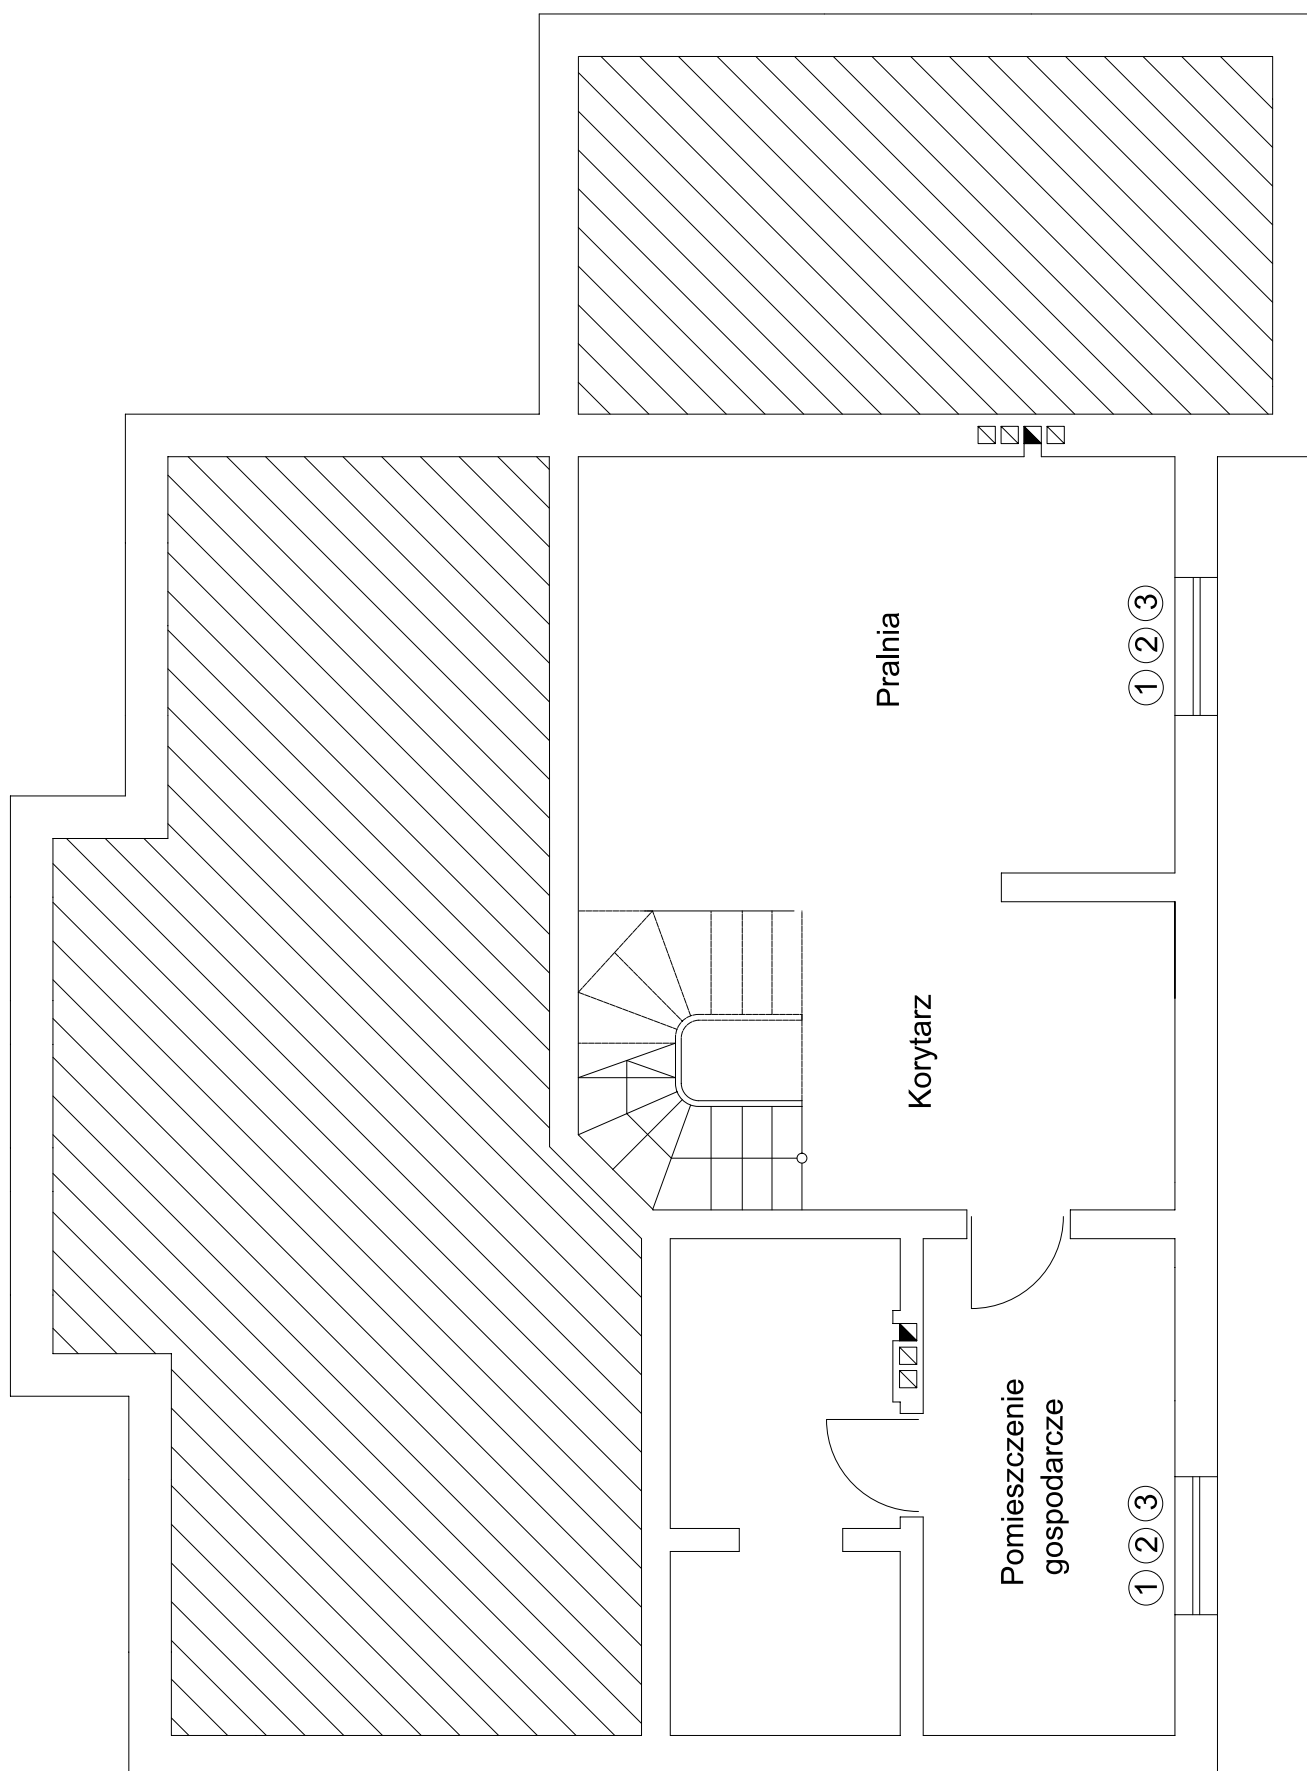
/12 Plan instalacji grzewczej - PARTER
